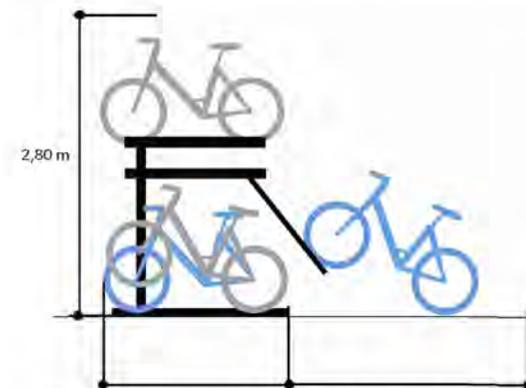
Rangement sur deux niveaux allié à une disposition resserrée
